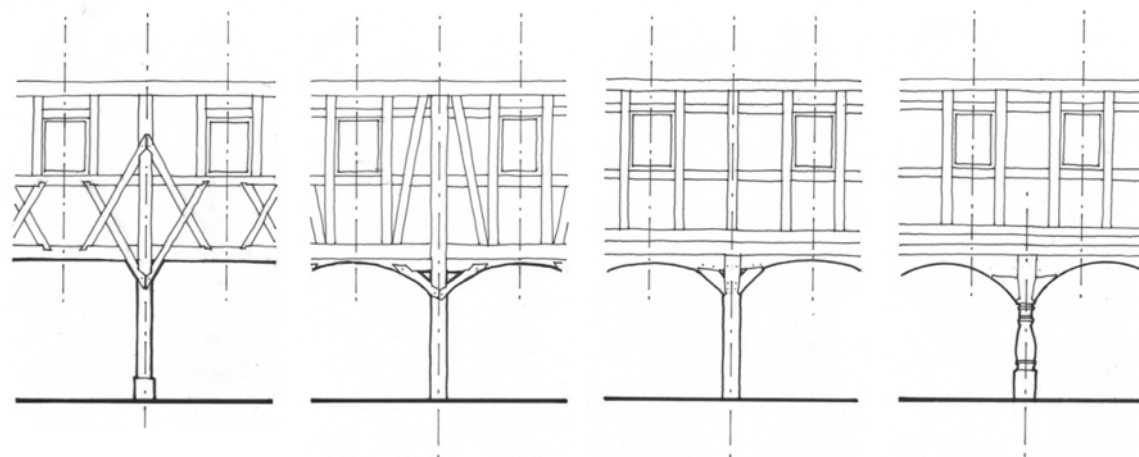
Variações estruturais evolutivas da construção Umgebinde segundo Breen. (Breen)
